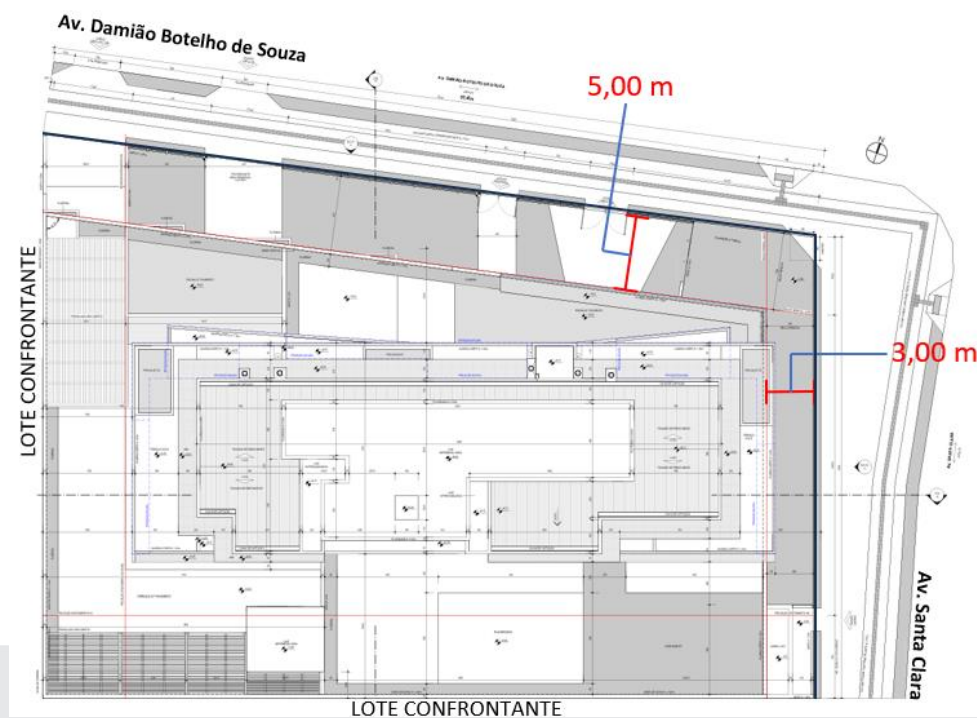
Implantação de projeto com recuos. Fonte: Projeto Simplificado: Habitação Coletiva, 2024, editado por SYDOR arquitetura, 2024.
